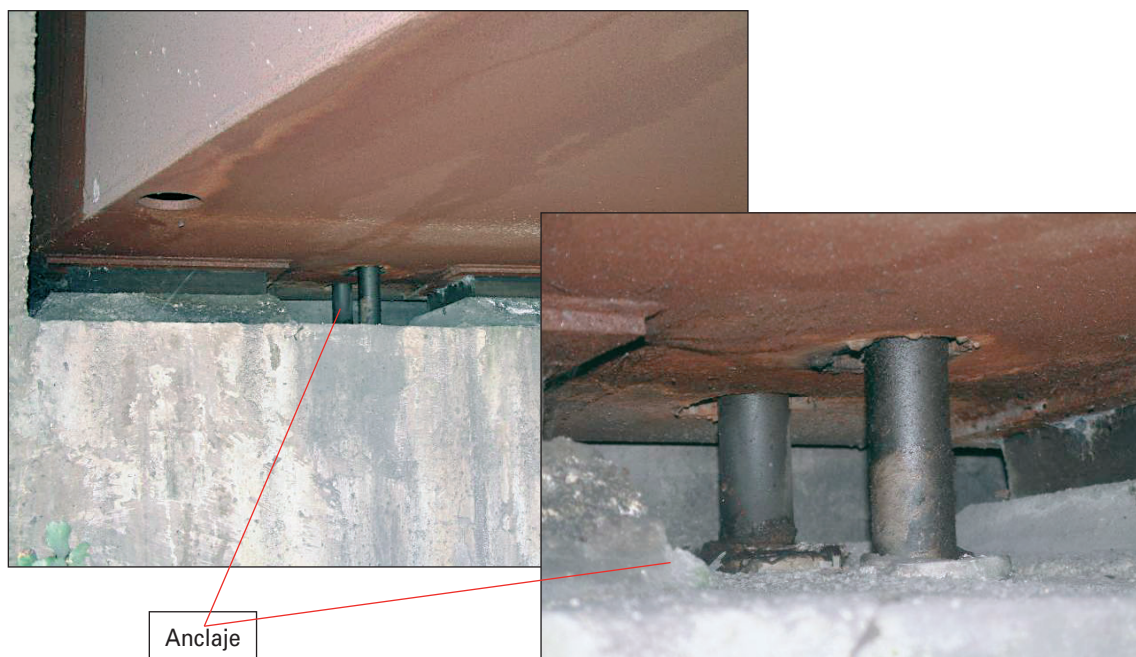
ANCLAJES ESTRIBO/TABLERO.
